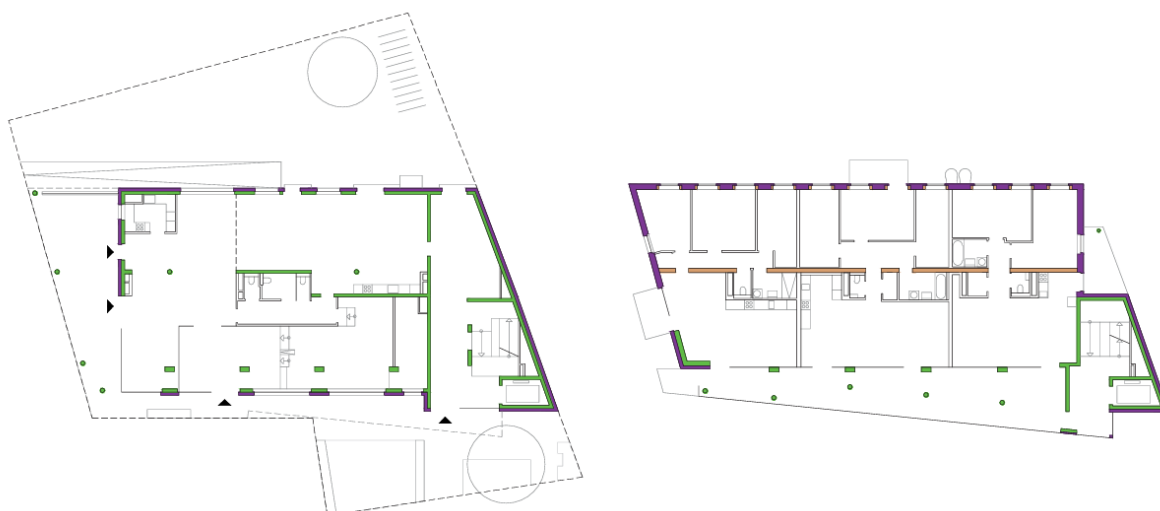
Bikes & Rails - Grundriss und Tragsystem - Erdgeschoss und Regelgeschoss (aus [126])
